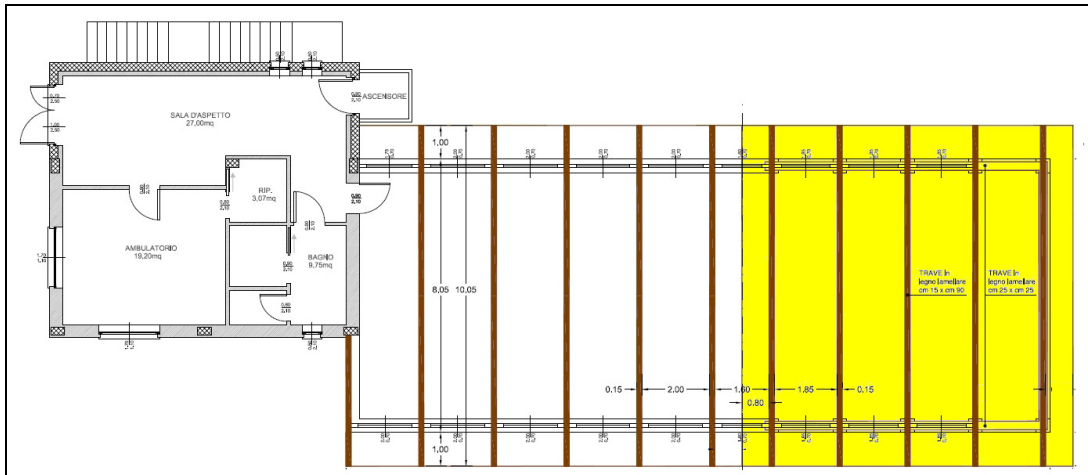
Progetto: pianta dell'orditura del tetto (tratta dalla Tavola n. 5)
